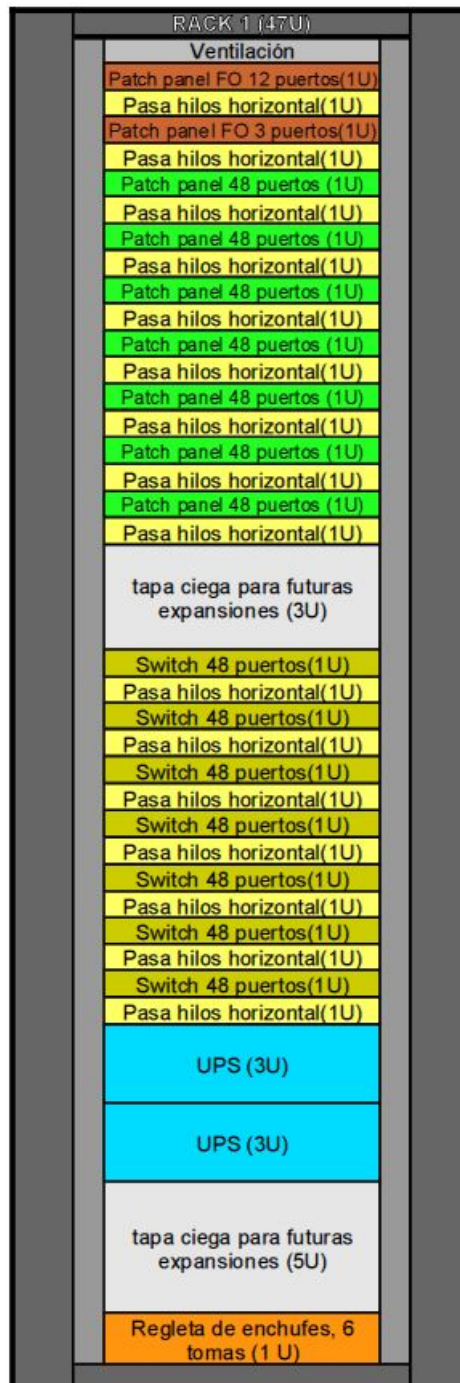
Distribución interior rack1, Primera Planta, Torre B
